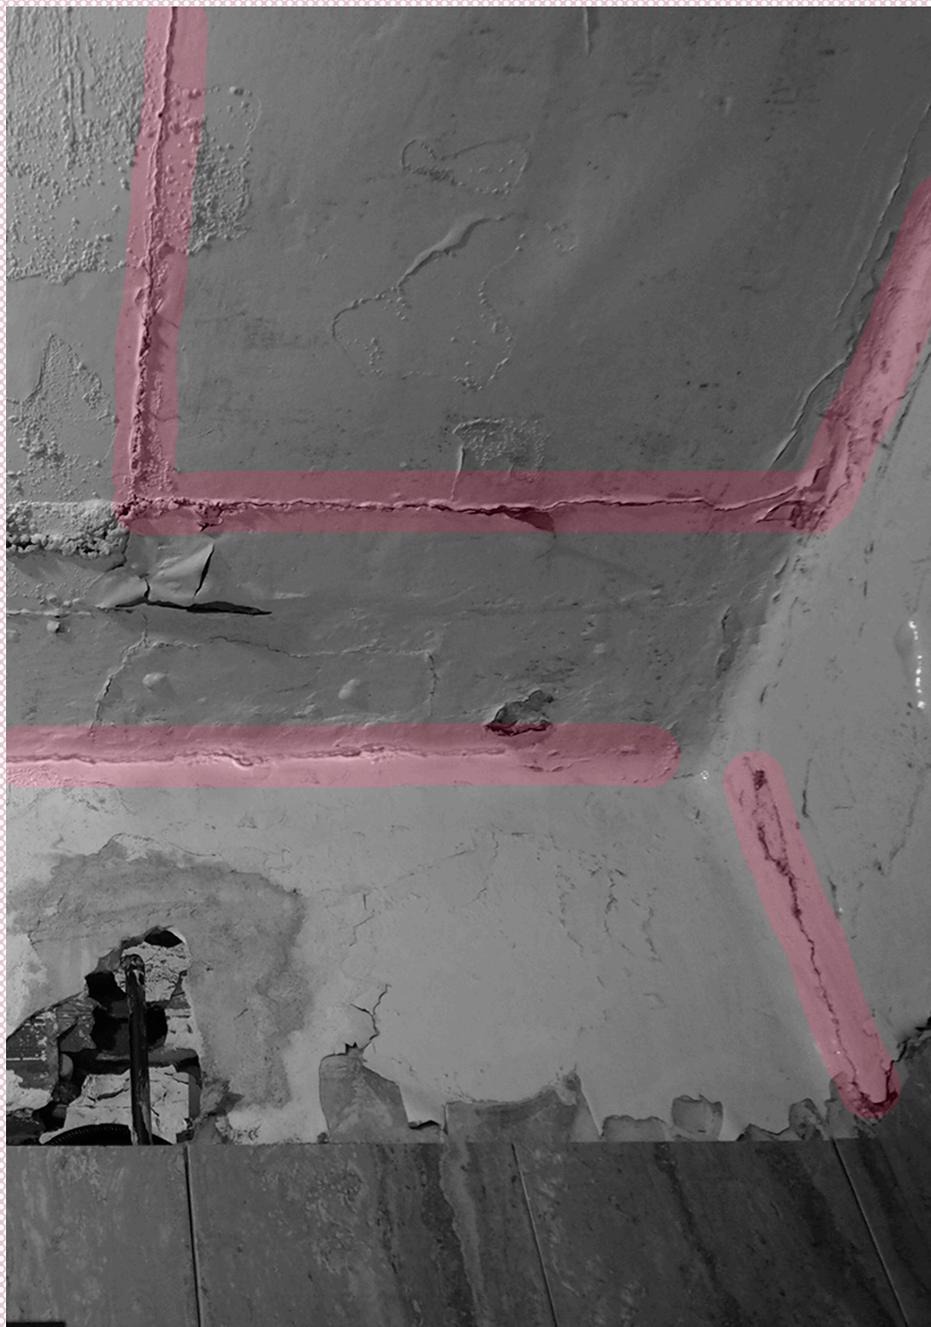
6.1 Fisuras en el perímetro del techo de la cocina
